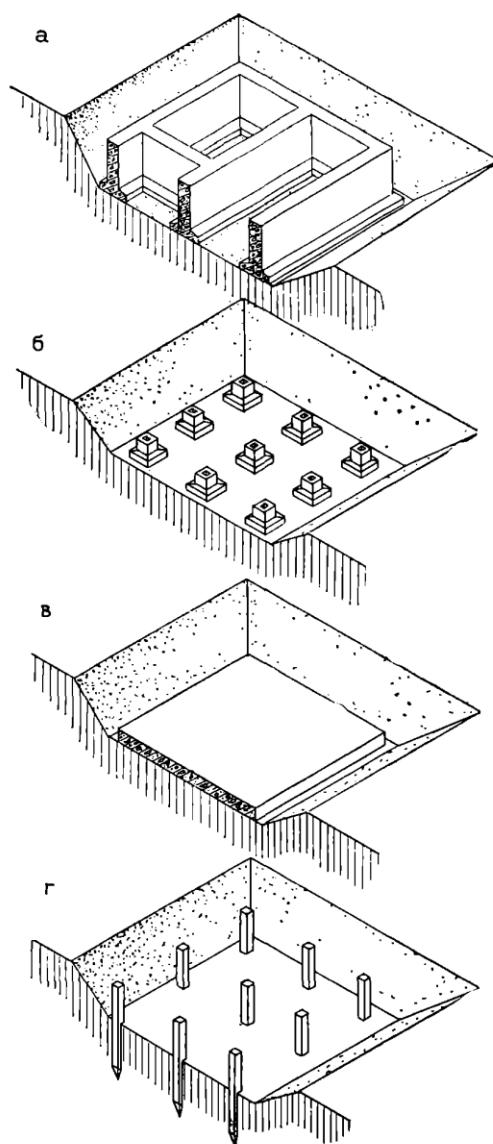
Конструктивные схемы фундаментов: а-ленточные; б-отдельно стоящие; в-сплошные; г-свайные
